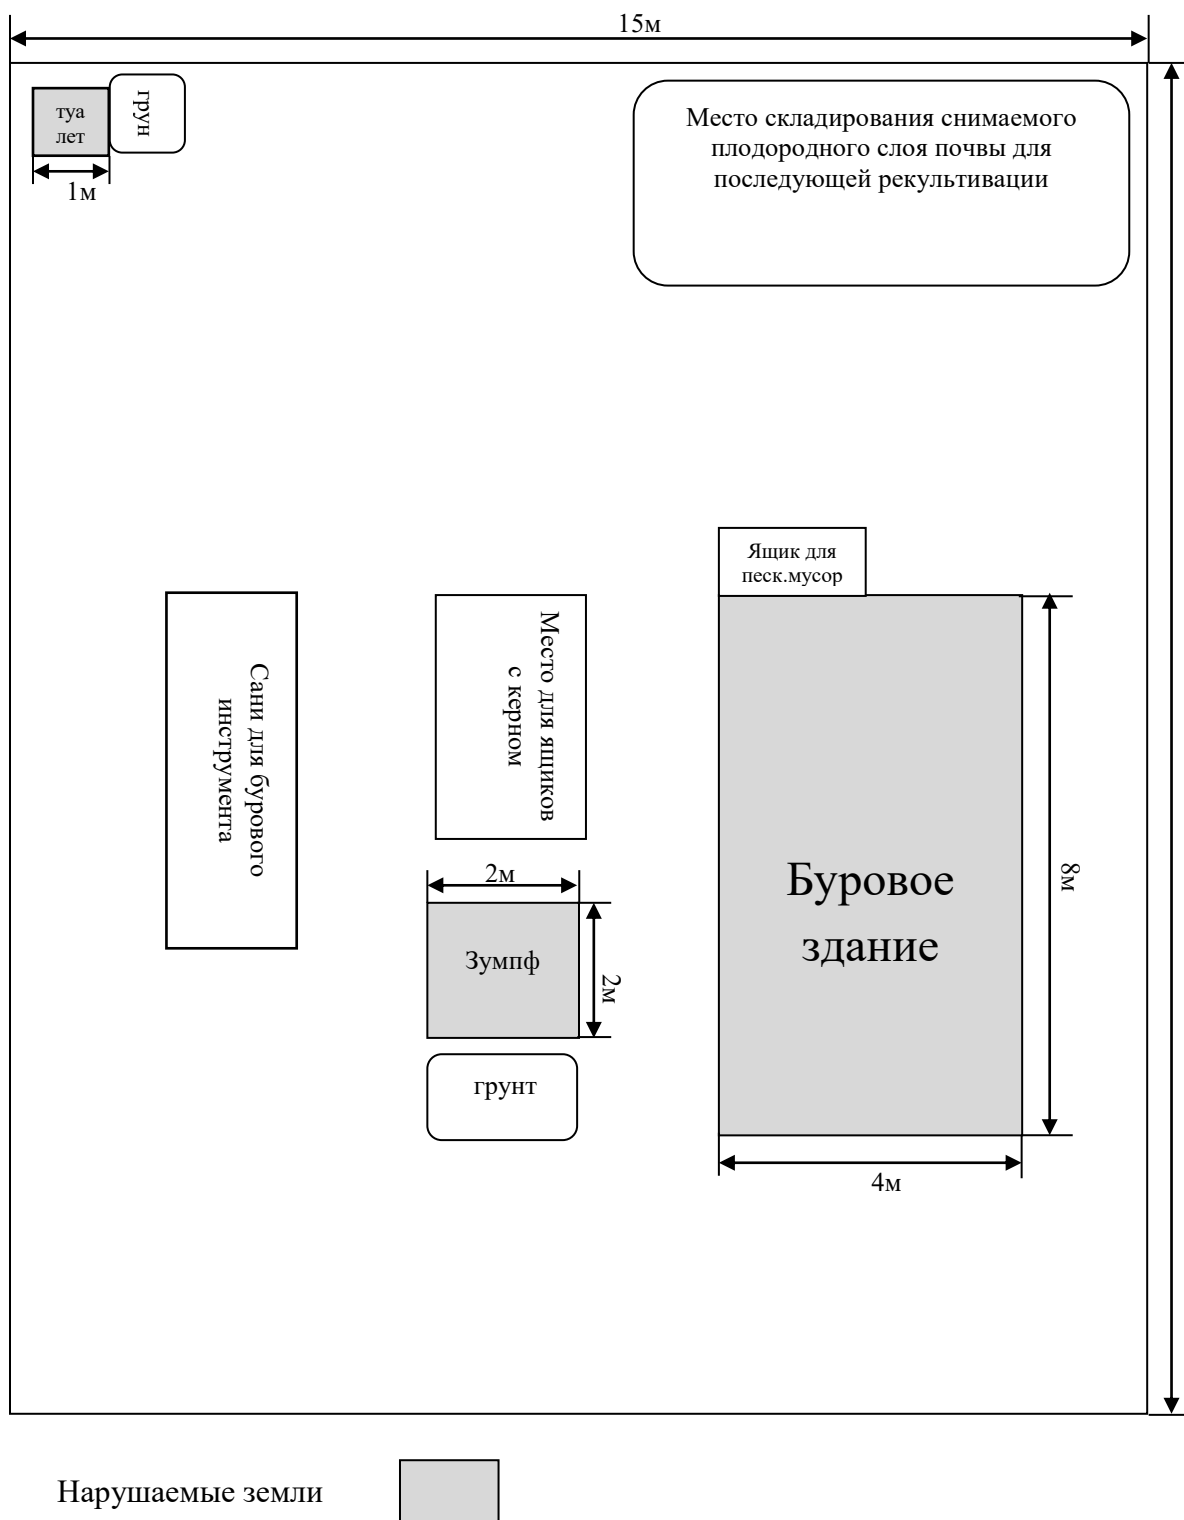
Схема размещения бурового оборудования на площадке
